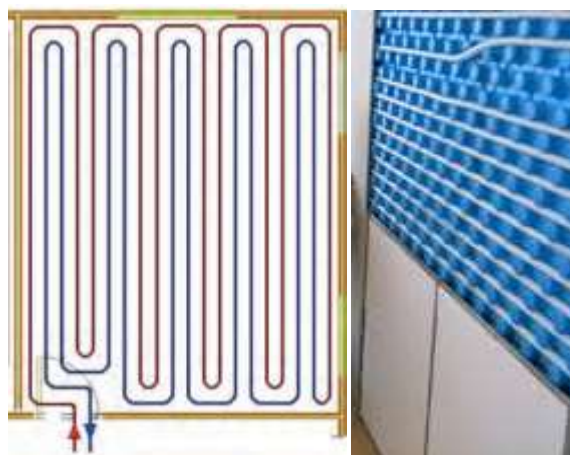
Distribución de tubería muro refrescante (UNE-UN-1264:2009)
